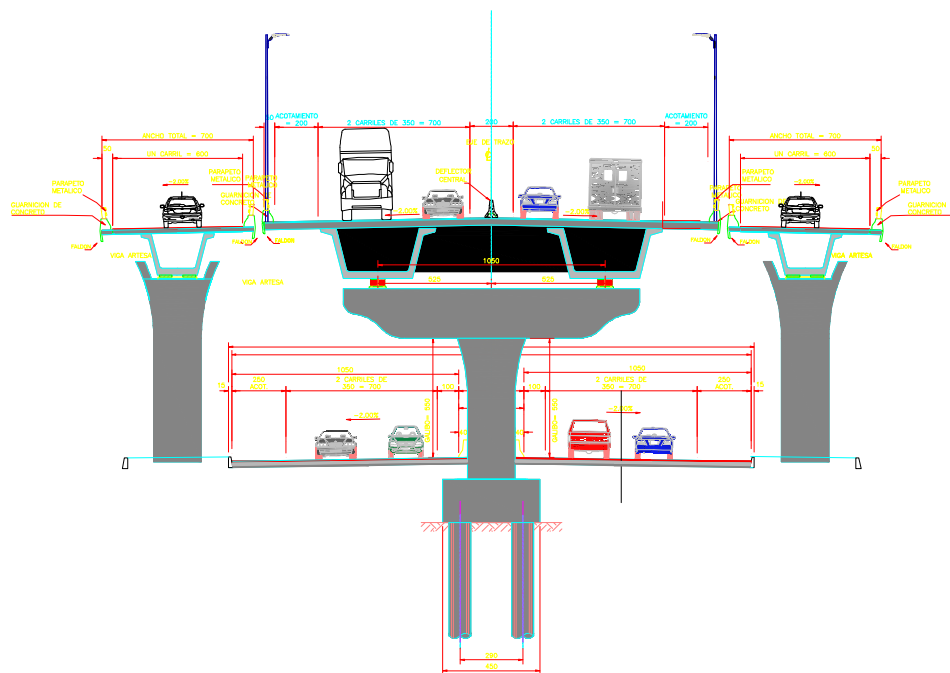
Sección transversal Tipo en Zona de Accesos. (Fuente: plano de planta general de proyecto)
